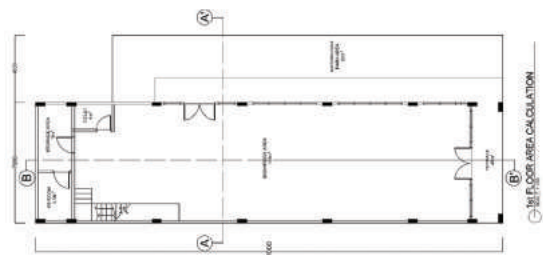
Denah Potongan Area TIP TOP Apparel & Bike
